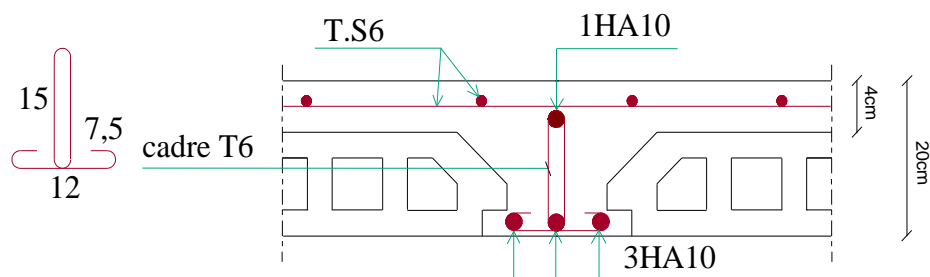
Schéma de ferrailage des poutrelles en travée.
